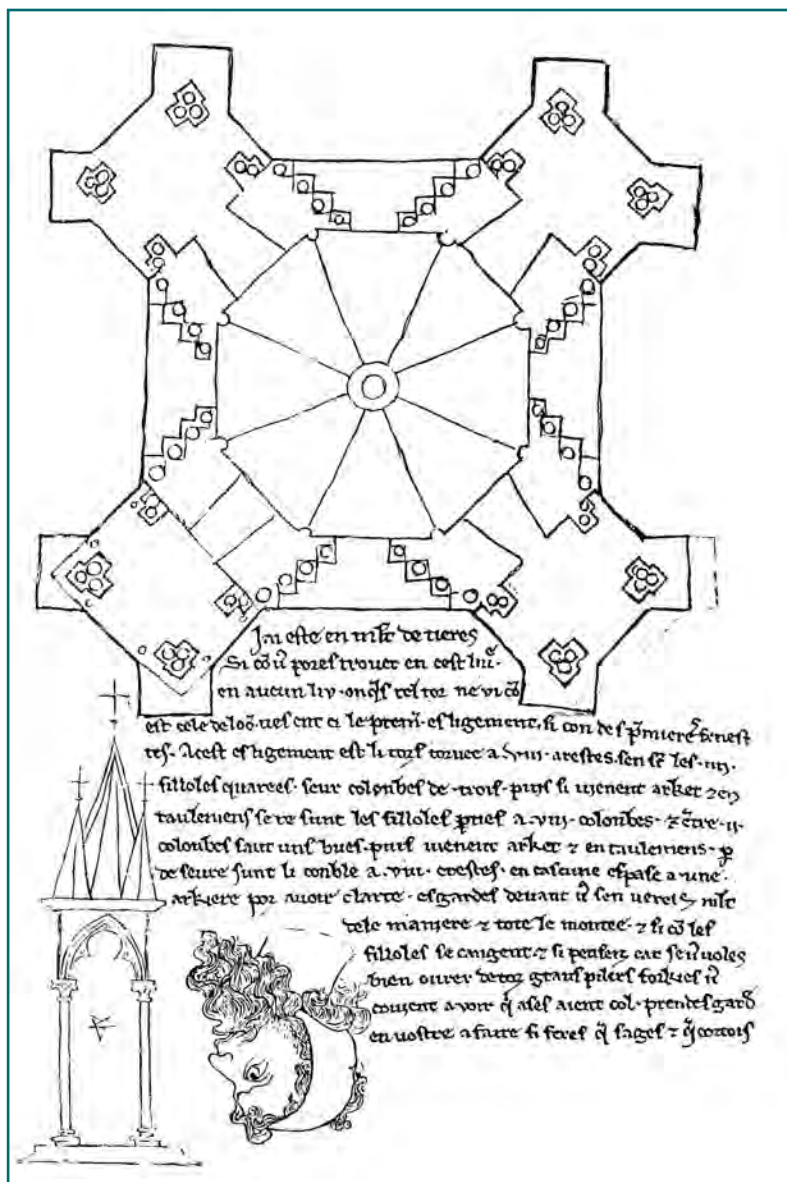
Planta de una torre de la catedral de Laon (Francia) realizada por Villard de Honnecourt [5].
